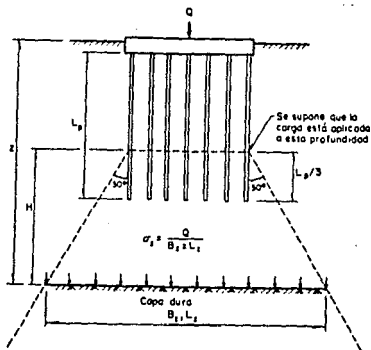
Distribución de esfuerzos bajo un grupo de pilotes de fricción en arcillas usando el concepto de la zapata teórica.
